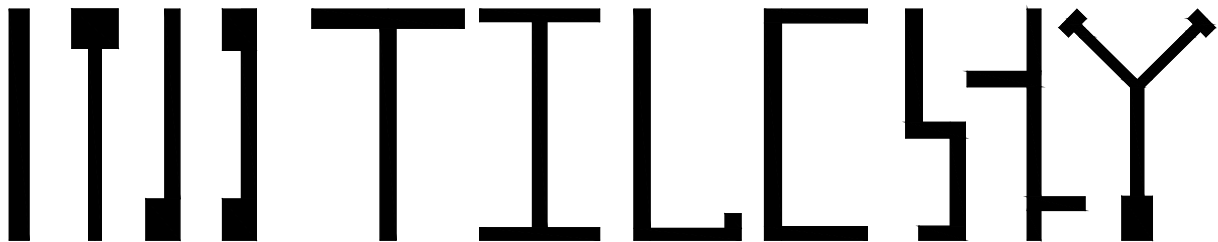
Secciones comunes de muros estructurales (Paulay et al., 1992)²³
